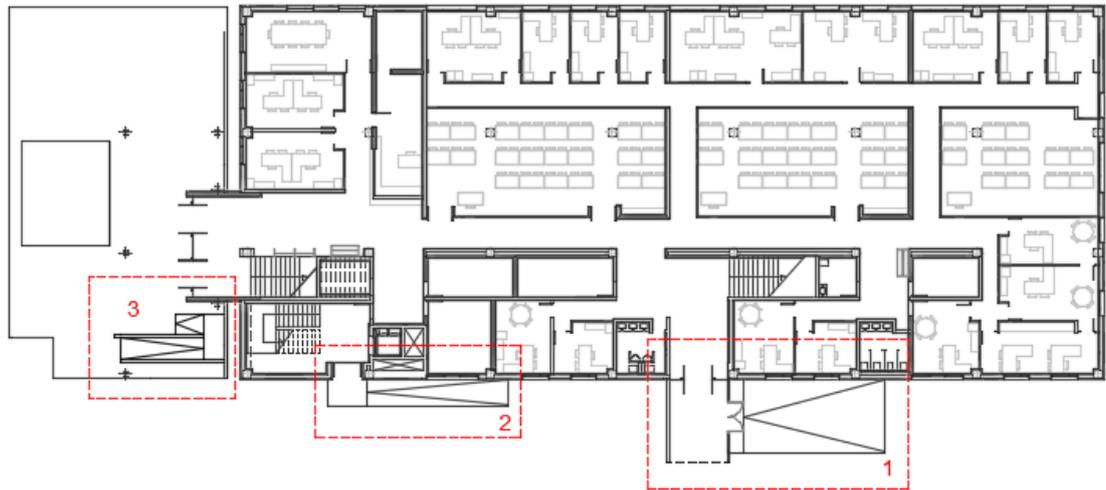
Situación rampas en edificio. Figura extraída del plano 2.
